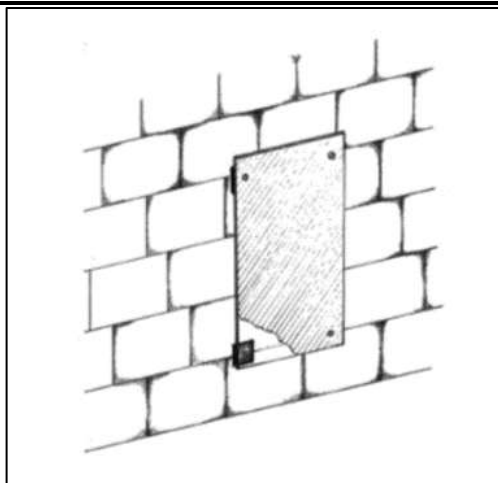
Illustration d'une plaque refuge pouvant être mise en pied de bâtiment
